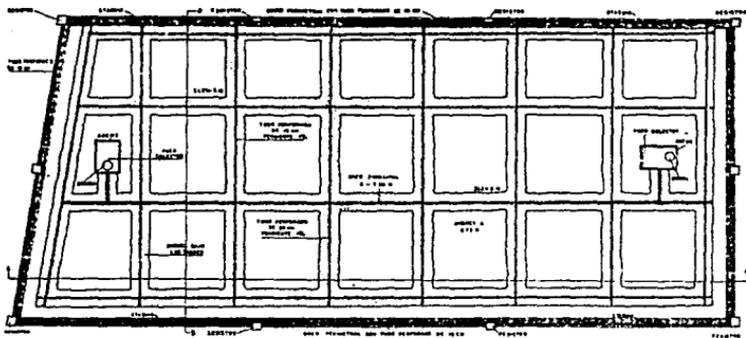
SISTEMA HIDRAULICO A BASE DE POZOS ABIERTOS EN UNA EXCAVACION
